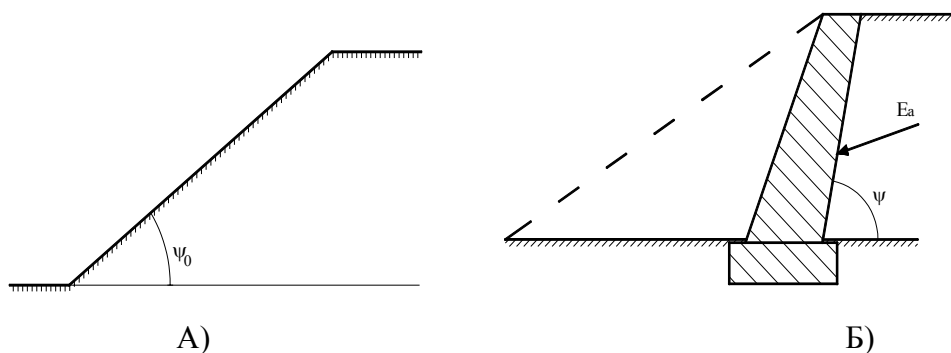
Откосы: а – естественный; б – удерживаемый от обрушения подпорной стеной
